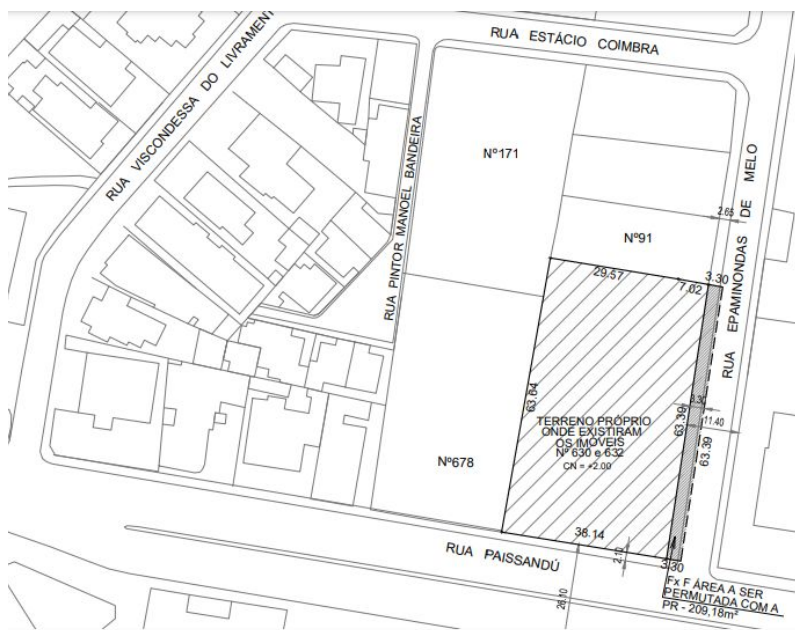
Planta de Situação. Fonte: Processo nº 8036748824
